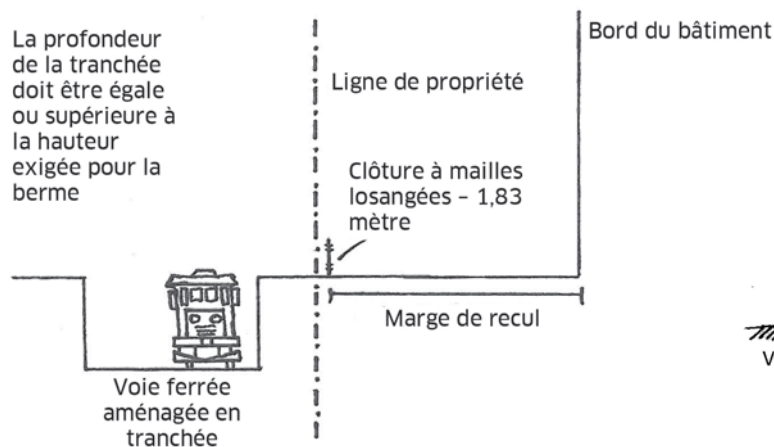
// LORSQUE LA VOIE FERRÉE EST CONSTRUITE DANS UNE TRANCHÉE D'UNE PROFONDEUR ÉQUIVALENTE, UNE BERME N'EST PAS EXIGÉE.
